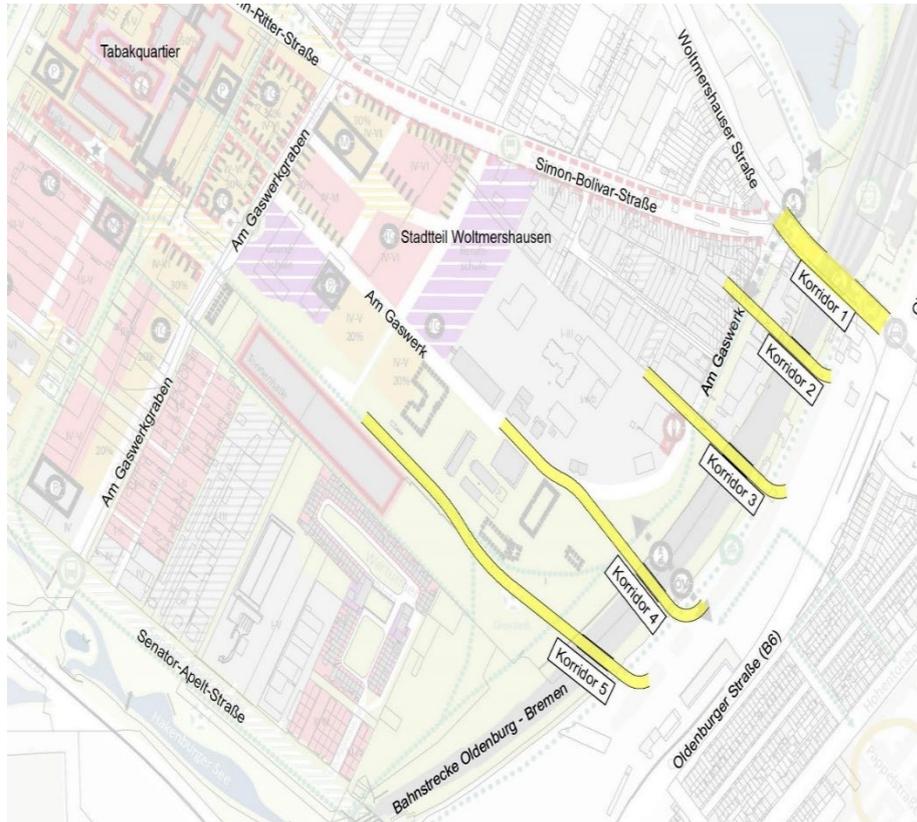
Übersichtslageplan geprüfte ÖPNV-Korridore., Stand Mai 2020
